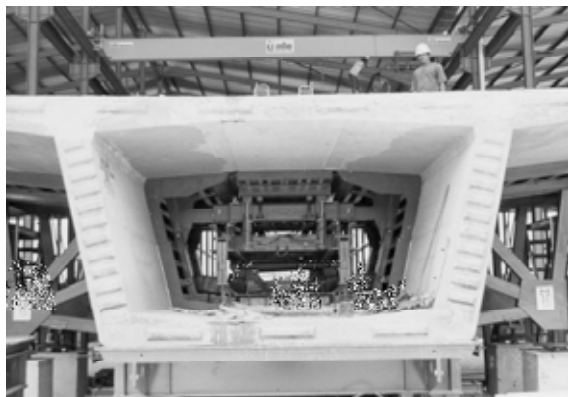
Dovela prefabricada de hormigón con llaves de cortante.
